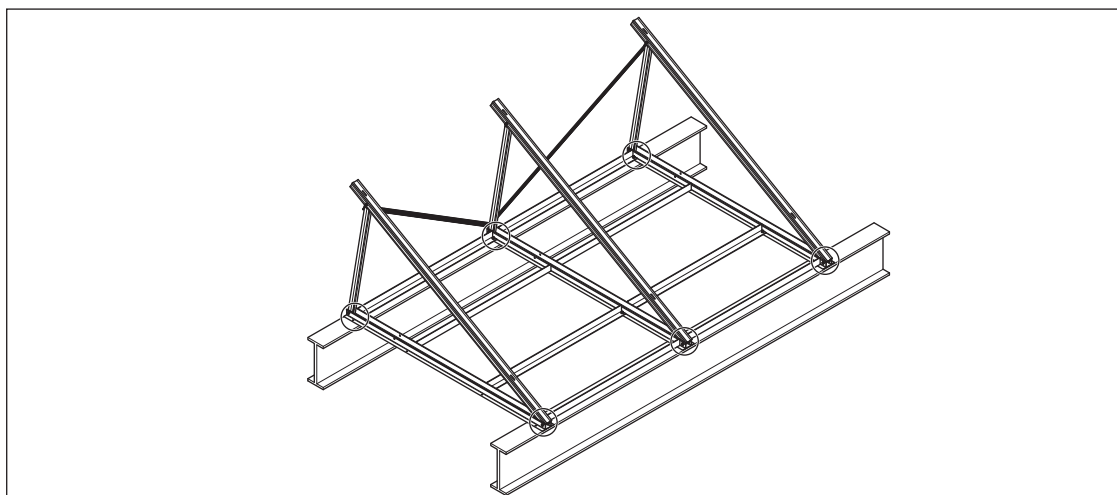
Sécurisation de construction autonome sur toit-terrasse par une ossature porteuse
